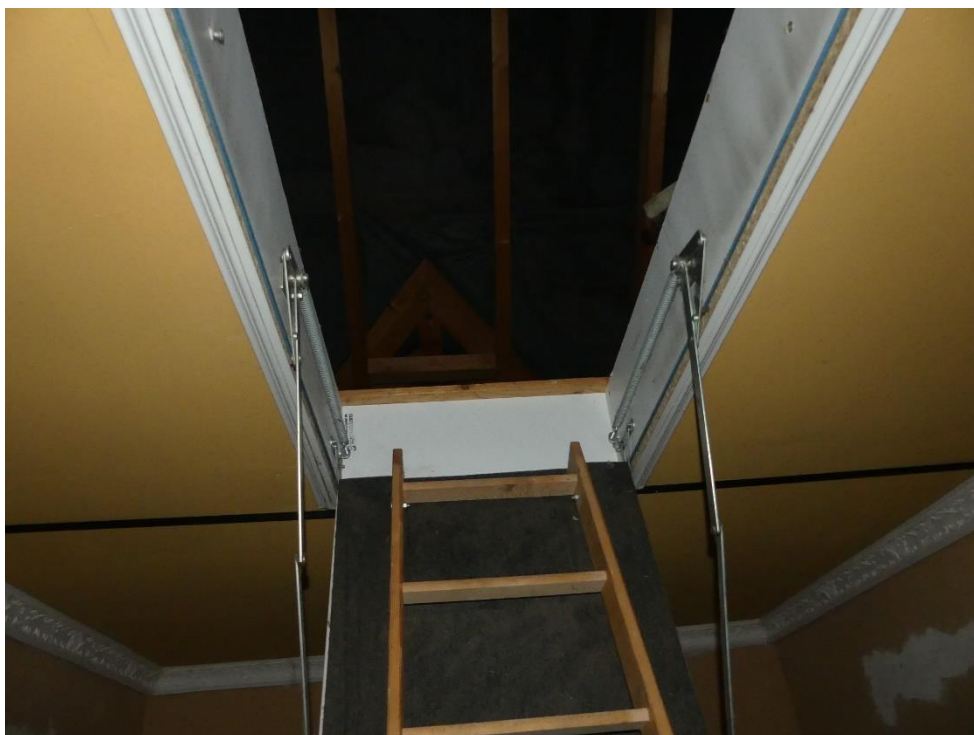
Zugang zum Dachboden Döbelner Straße 25a
